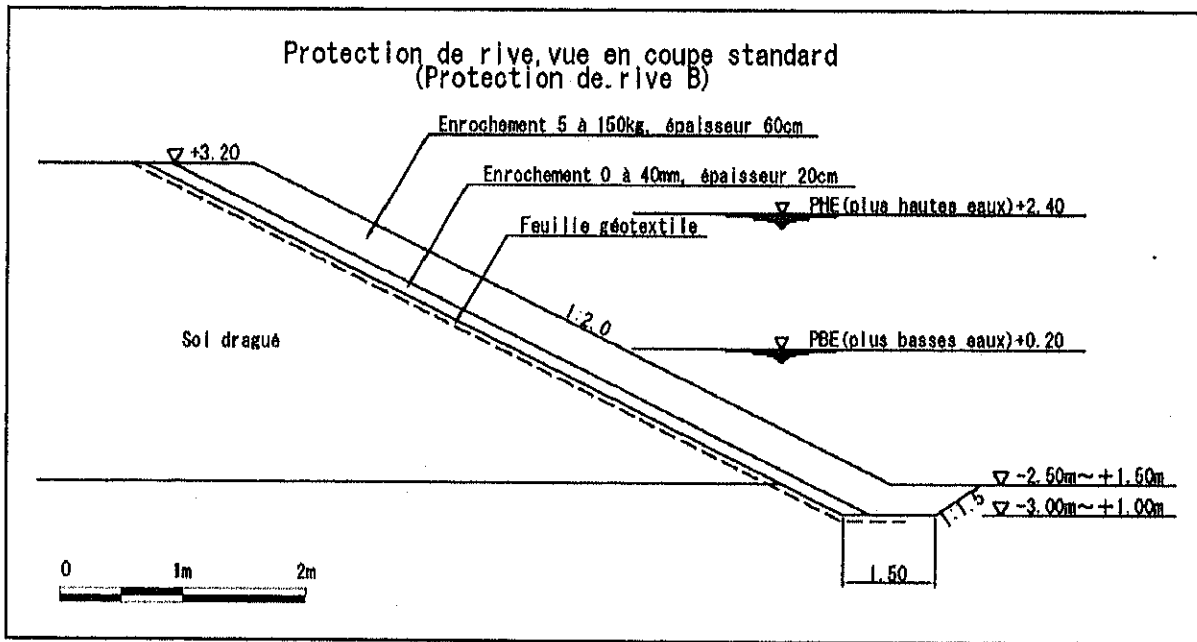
(6-2) Plan transversal typique de digue (Digue B : extrémité Ouest du quai)
